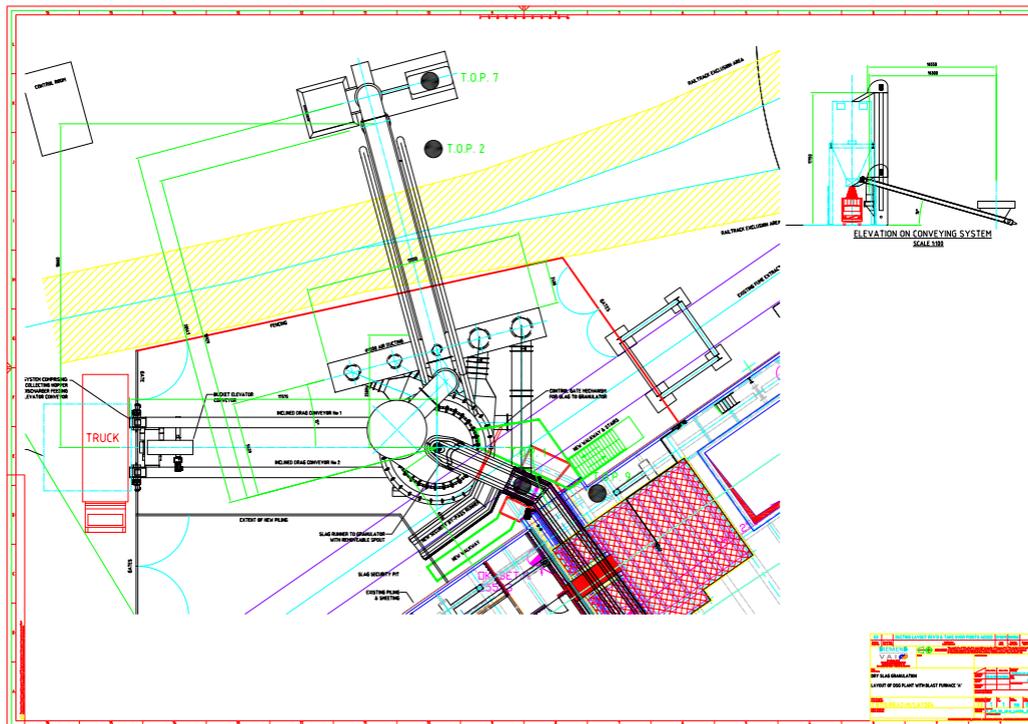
Layout Entwurf Prototyp-Versuchsanlage für Anlagenstandort Nordhalle Notgießbeet des Hochofens #A (Stand Februar 2014)
